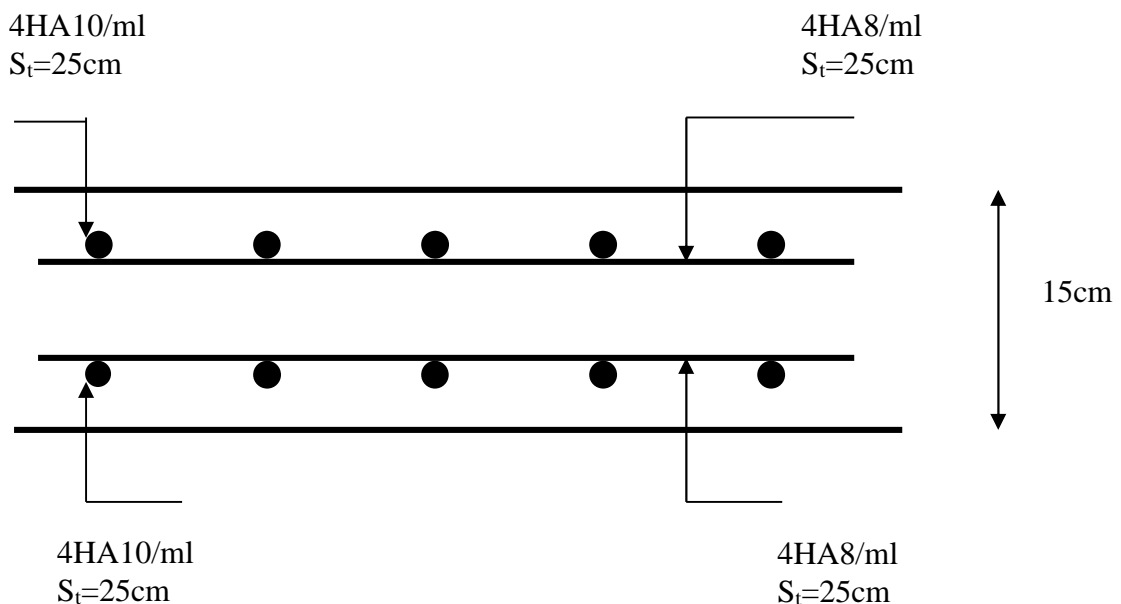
Ferrailage de la dalle de la salle machine
